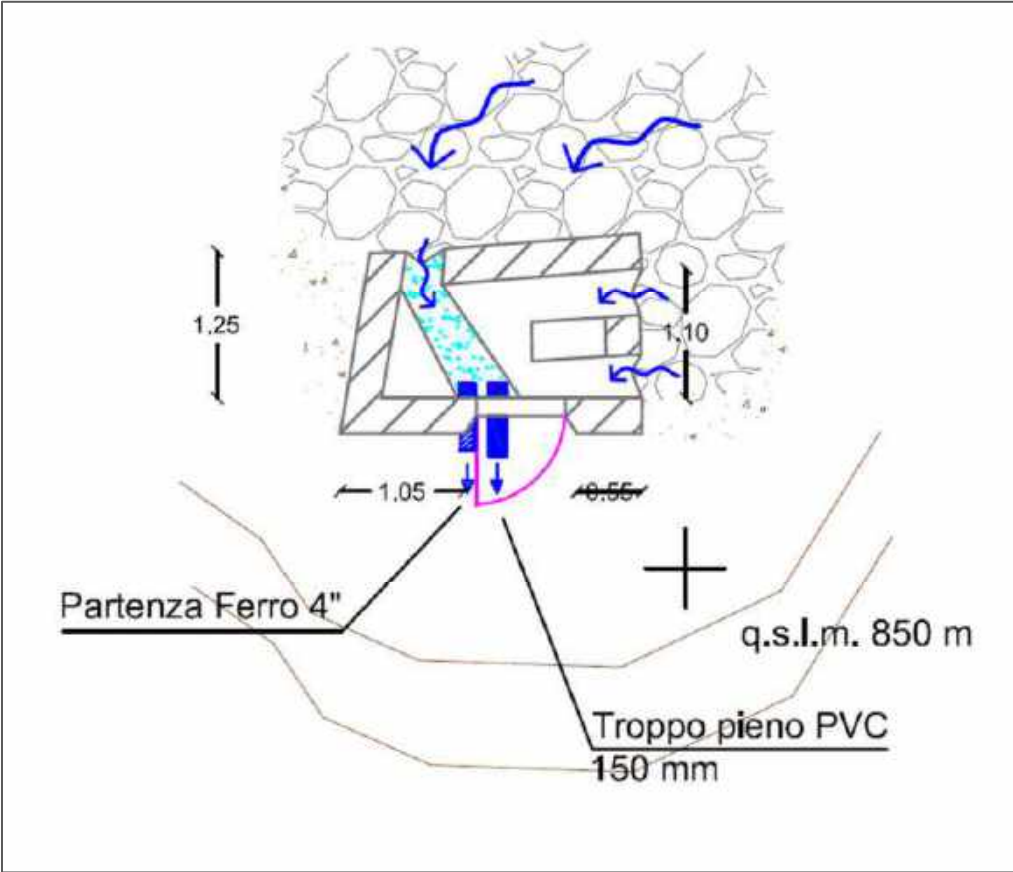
Pianta e Prospetto frontale Sorgente 2 Le Mesore
